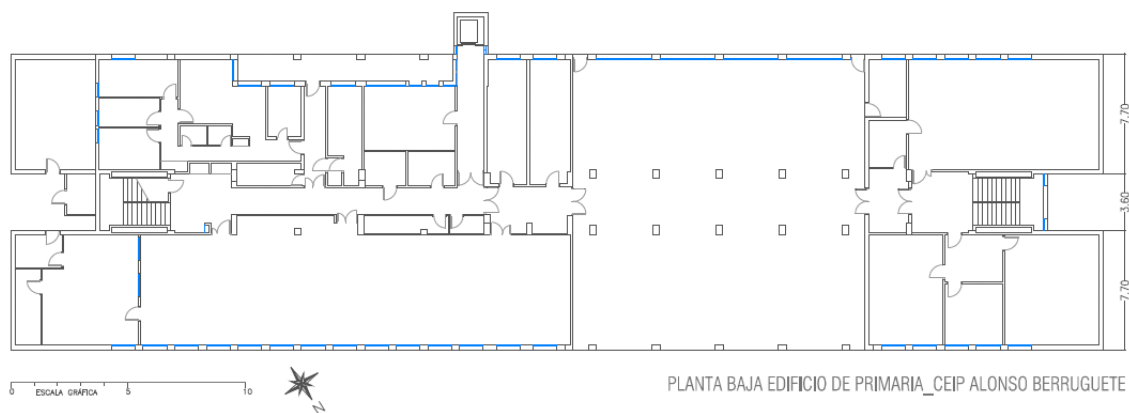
Planta baja CEIP Alonso Berruguete. Archivo Histórico Provincial de Valladolid, Sección Educación, caja 78/28, carpeta 2.
